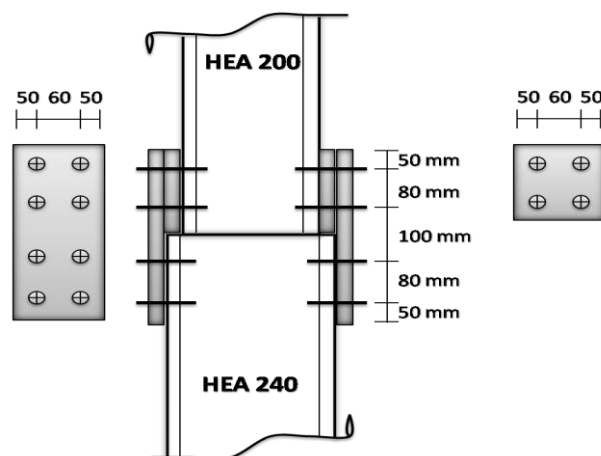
Assemblage poteau-poteau "couvre-joint de la semelle"
